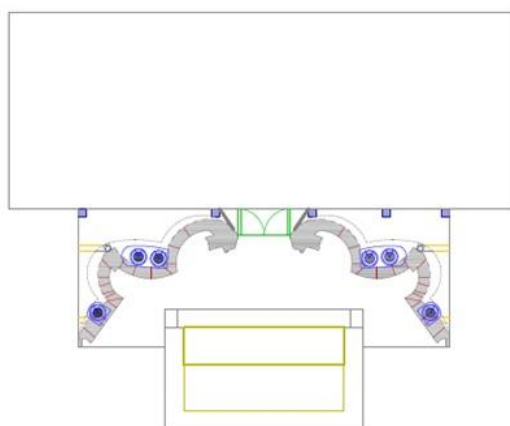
Caixa de implantação do tardoz (parte superior da imagem); planta do retábulo (parte intermédia da imagem); planta do altar (parte inferior da imagem).
